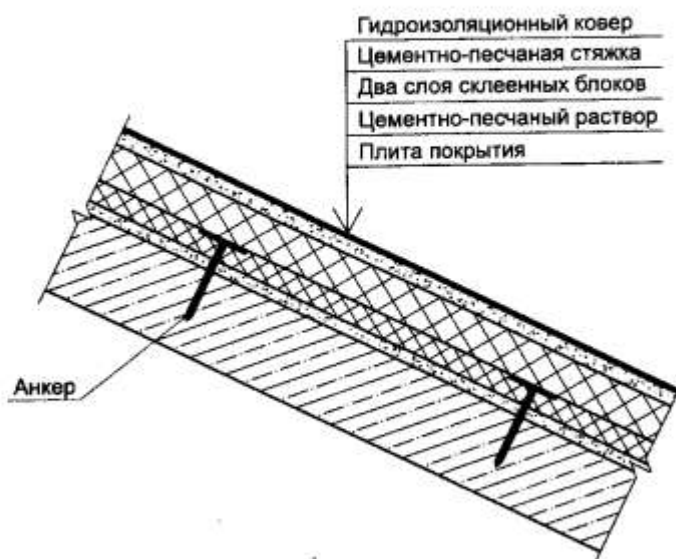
Тепловая изоляция совмещенной кровли с уклоном более 25 %
